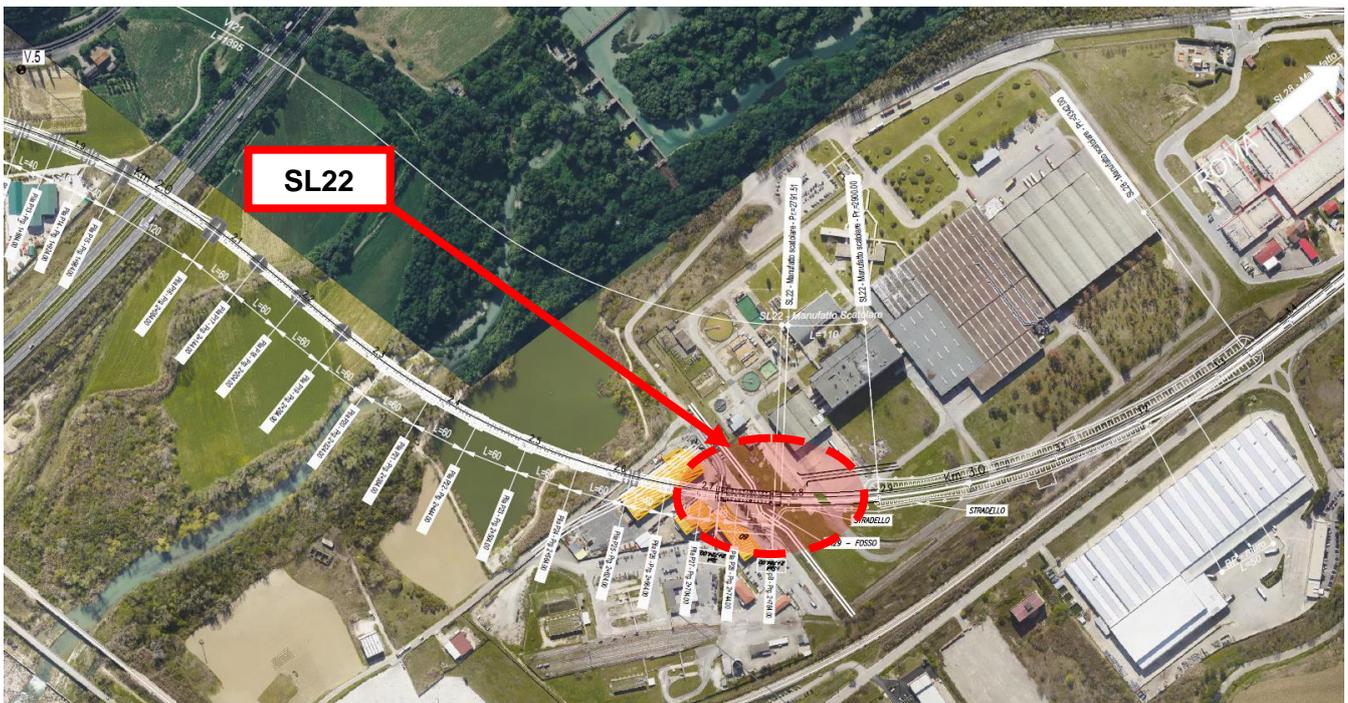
Inquadramento planimetrico sottopasso SL22
